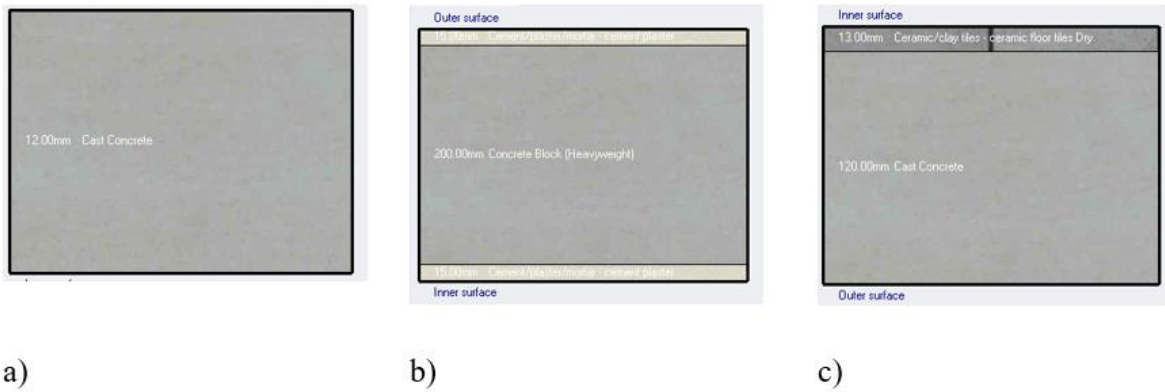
Representação dos elementos construtivos - a) cobertura, b) paredes e c) pavimento
